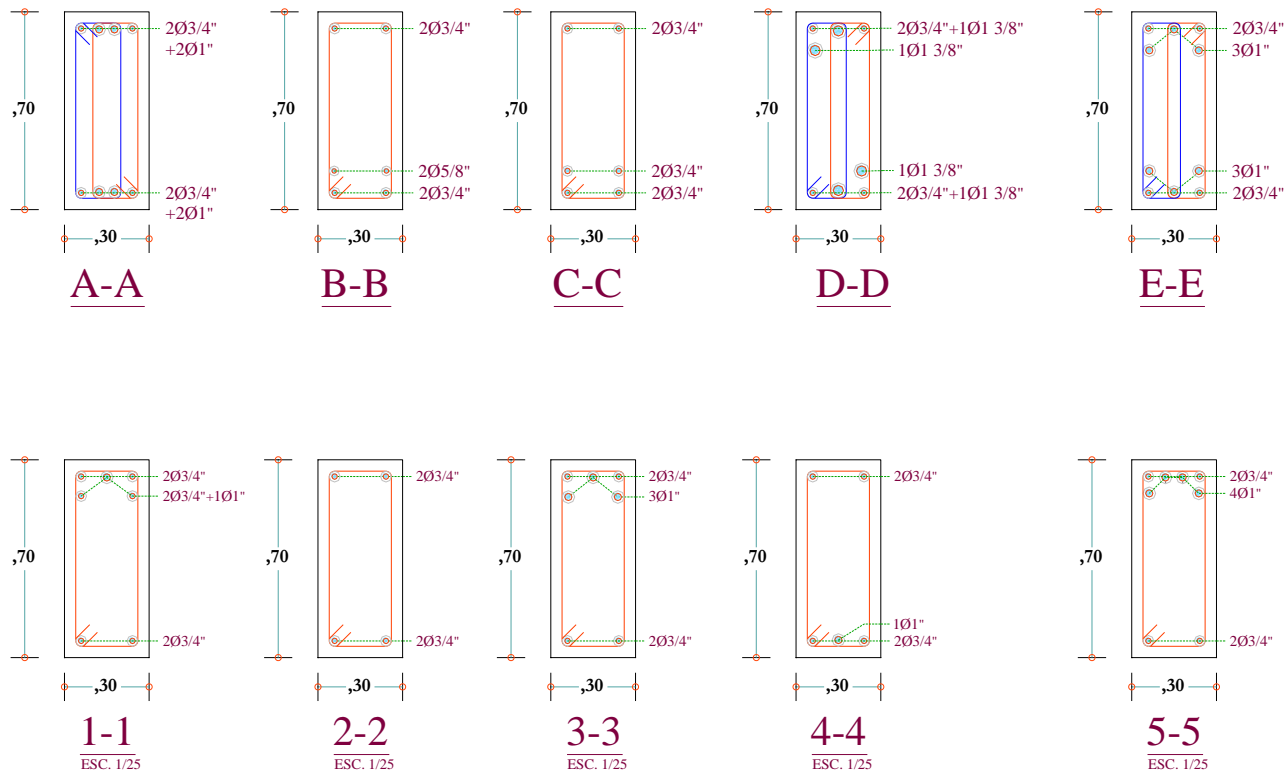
Sección de diseño, viga VC1, viga del pórtico C, primer nivel
